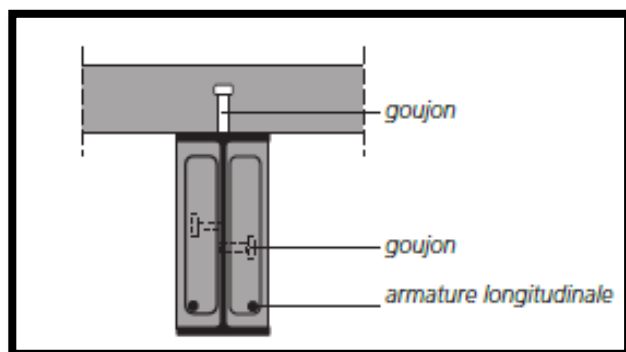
Coupe d'une poutre mixte ¹⁵⁵
